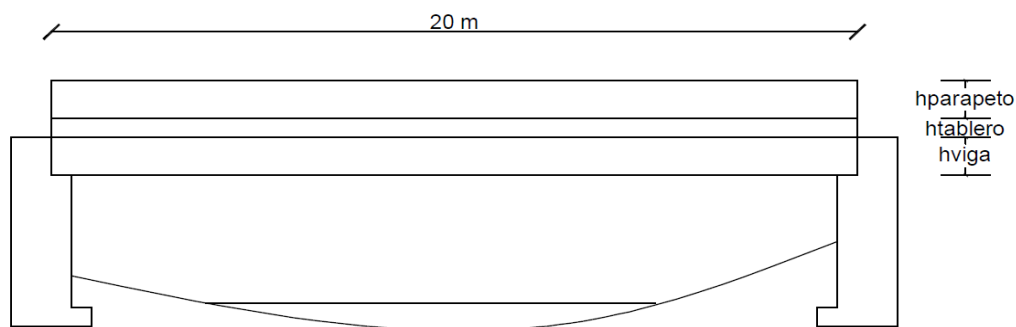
Sección longitudinal de la superestructura. Elaborado por: El autor
